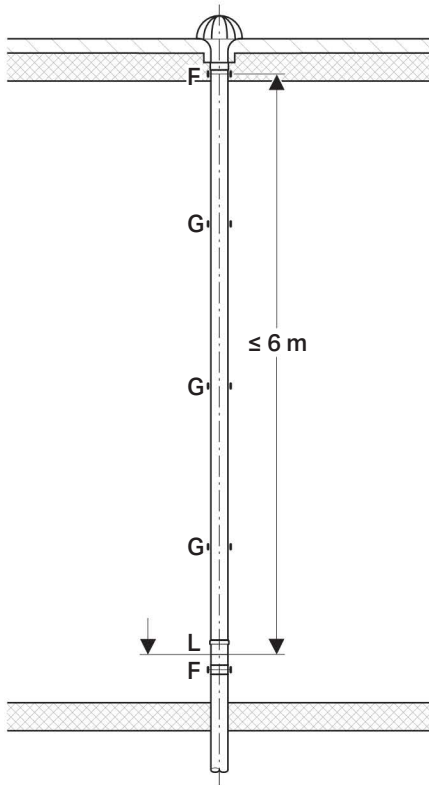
Beispiel C: Dachwasserfalleitung mit Langmuffe als Fixpunkt
